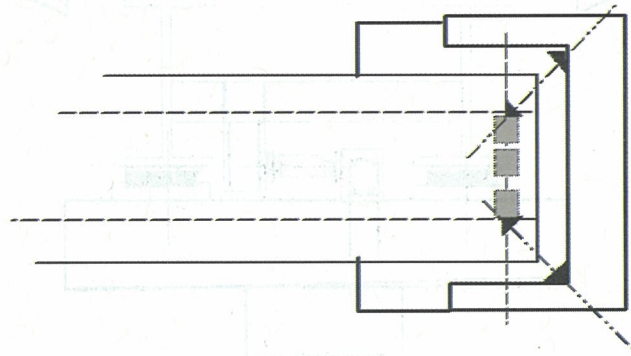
Dispositifs parasismiques installés à 45° en extrémité d'un pont dalle type PSDP ou similaire
